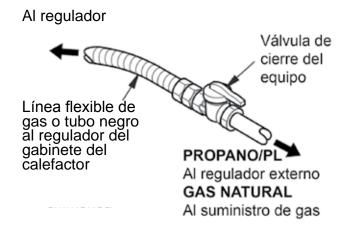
Instalación de la línea flexible de gas a la válvula de cierre del equipo
